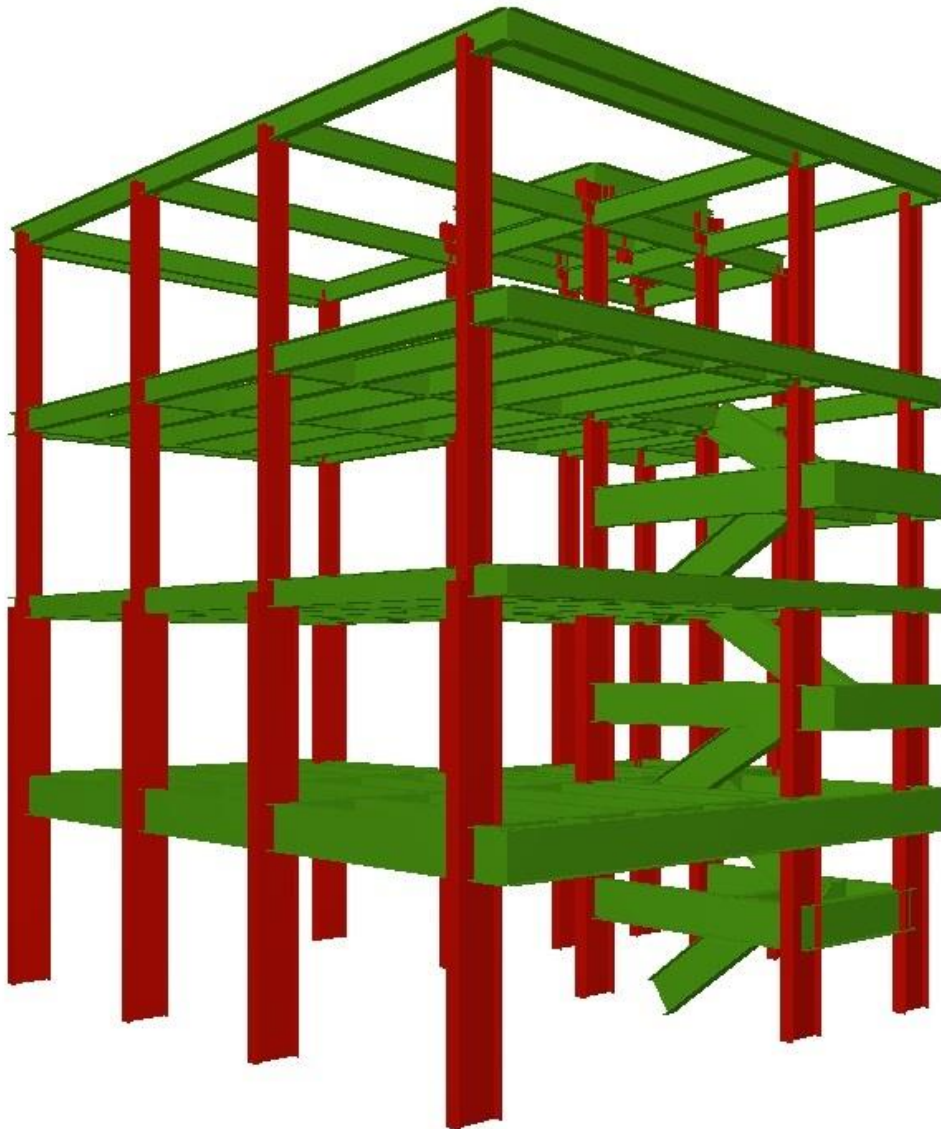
Lançamento da estrutura e verificação. Fonte: autores.
